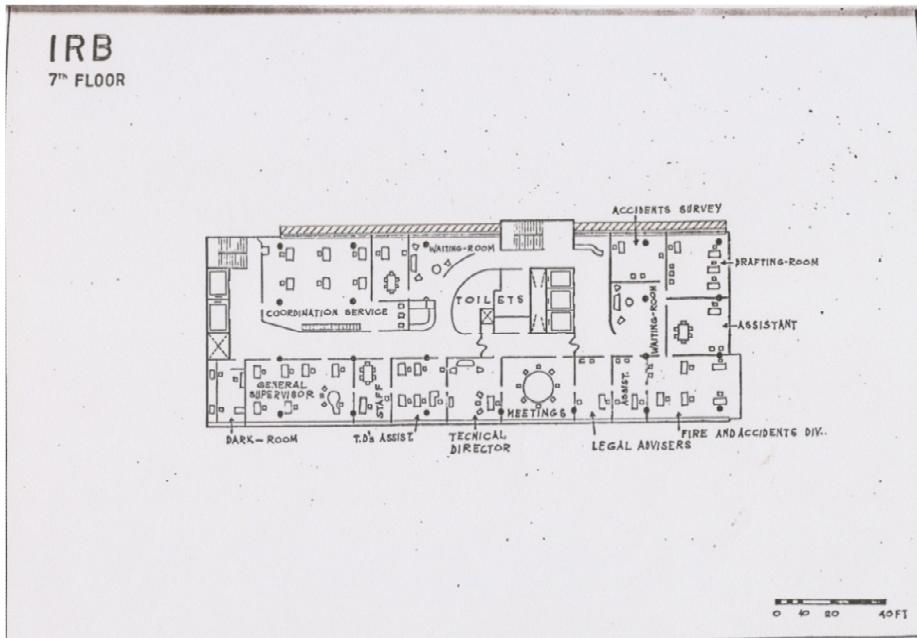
M – Planta baixa sétimo pavimento (andares corridos)
